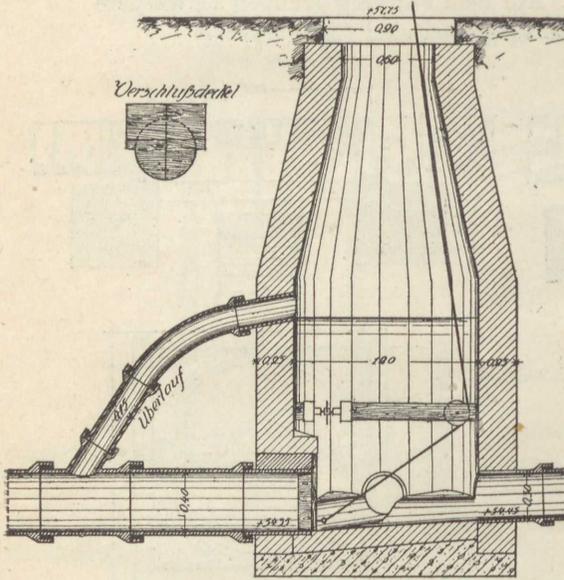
Einsteigeschacht einer Steinzeugrohrleitung mit Spüleinrichtung und Überlauf.
